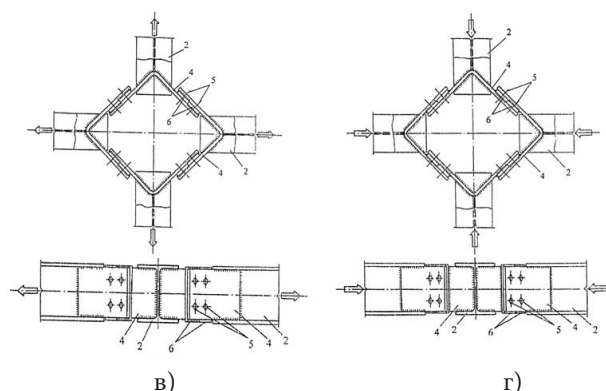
Схемы предлагаемых узловых соединений перекрестных стержневых конструкций:
